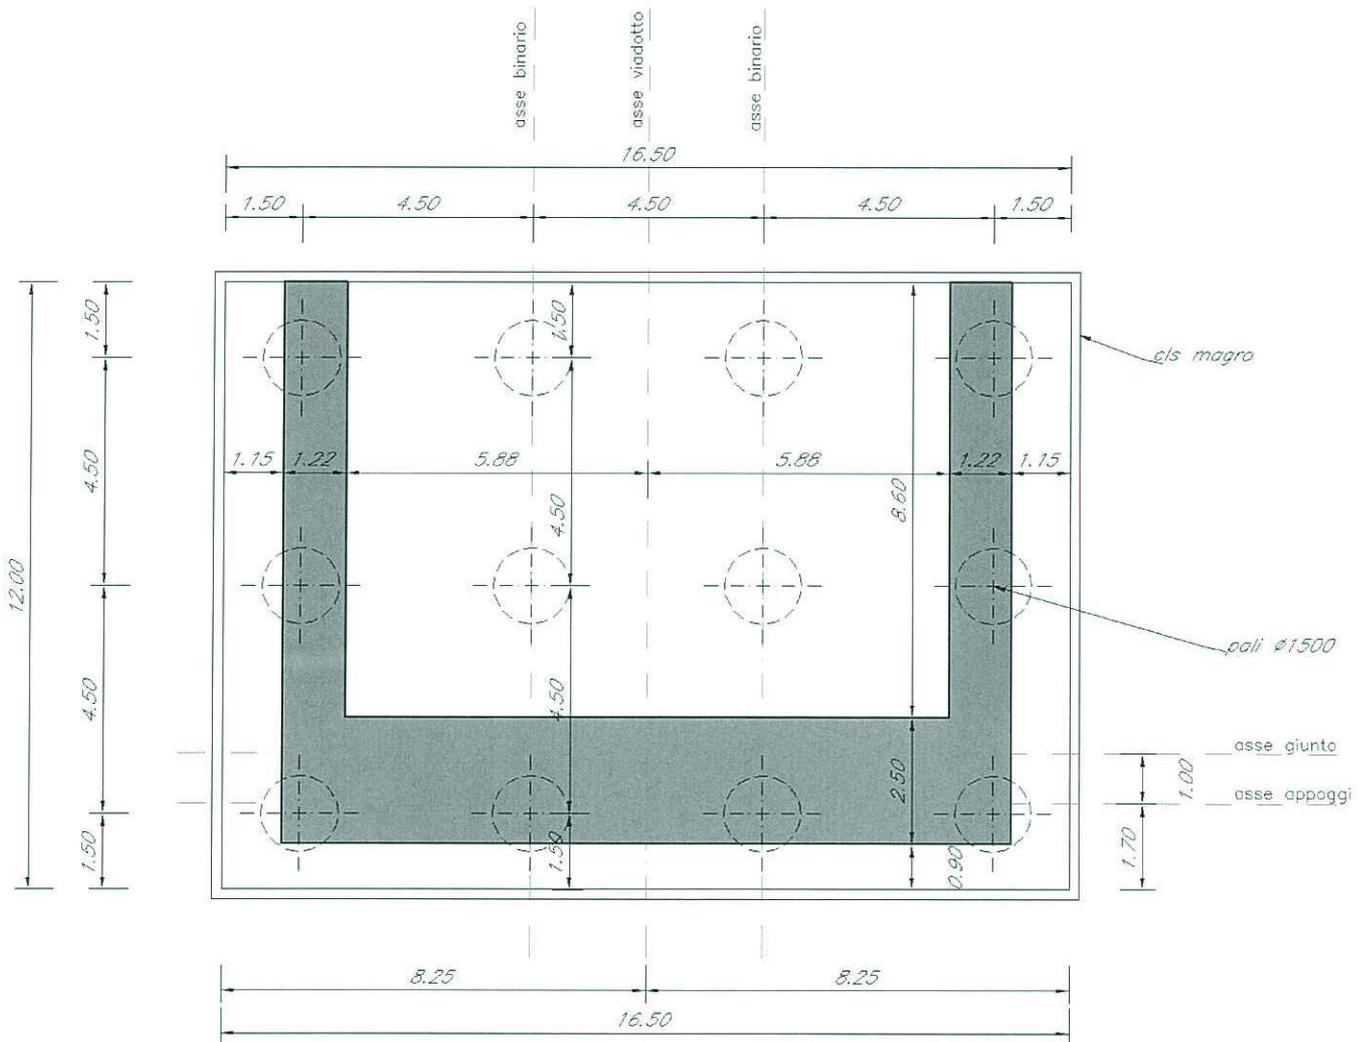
Pianta fondazioni della spalla tipo.
